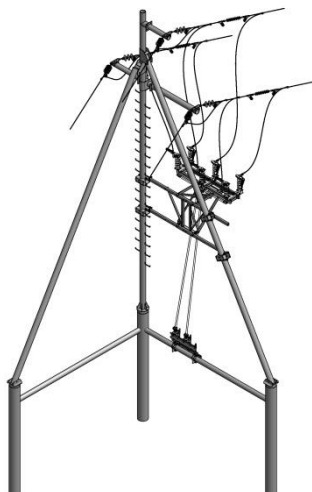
Установка разъединителя на опору ПУАт35-1 (опора из обсадных труб)
